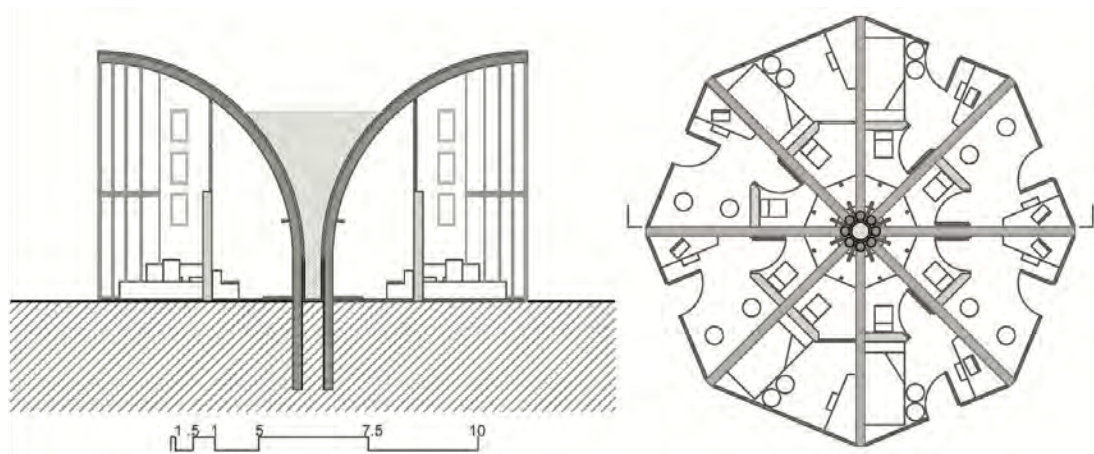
Sistema prefabricado para la construcción de viviendas provisionales de bajo coste.
